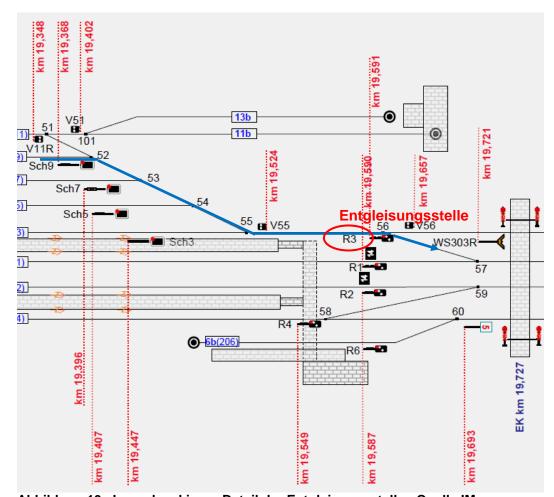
Lageplanskizze - Detail der Entgleisungsstelle - Quelle IM
